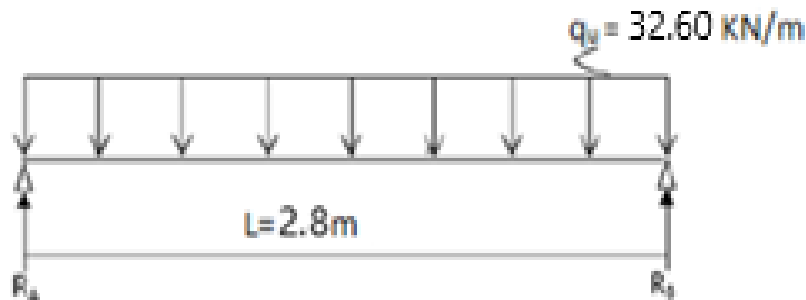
Schéma statique de la poutre palière a l’ELU.
